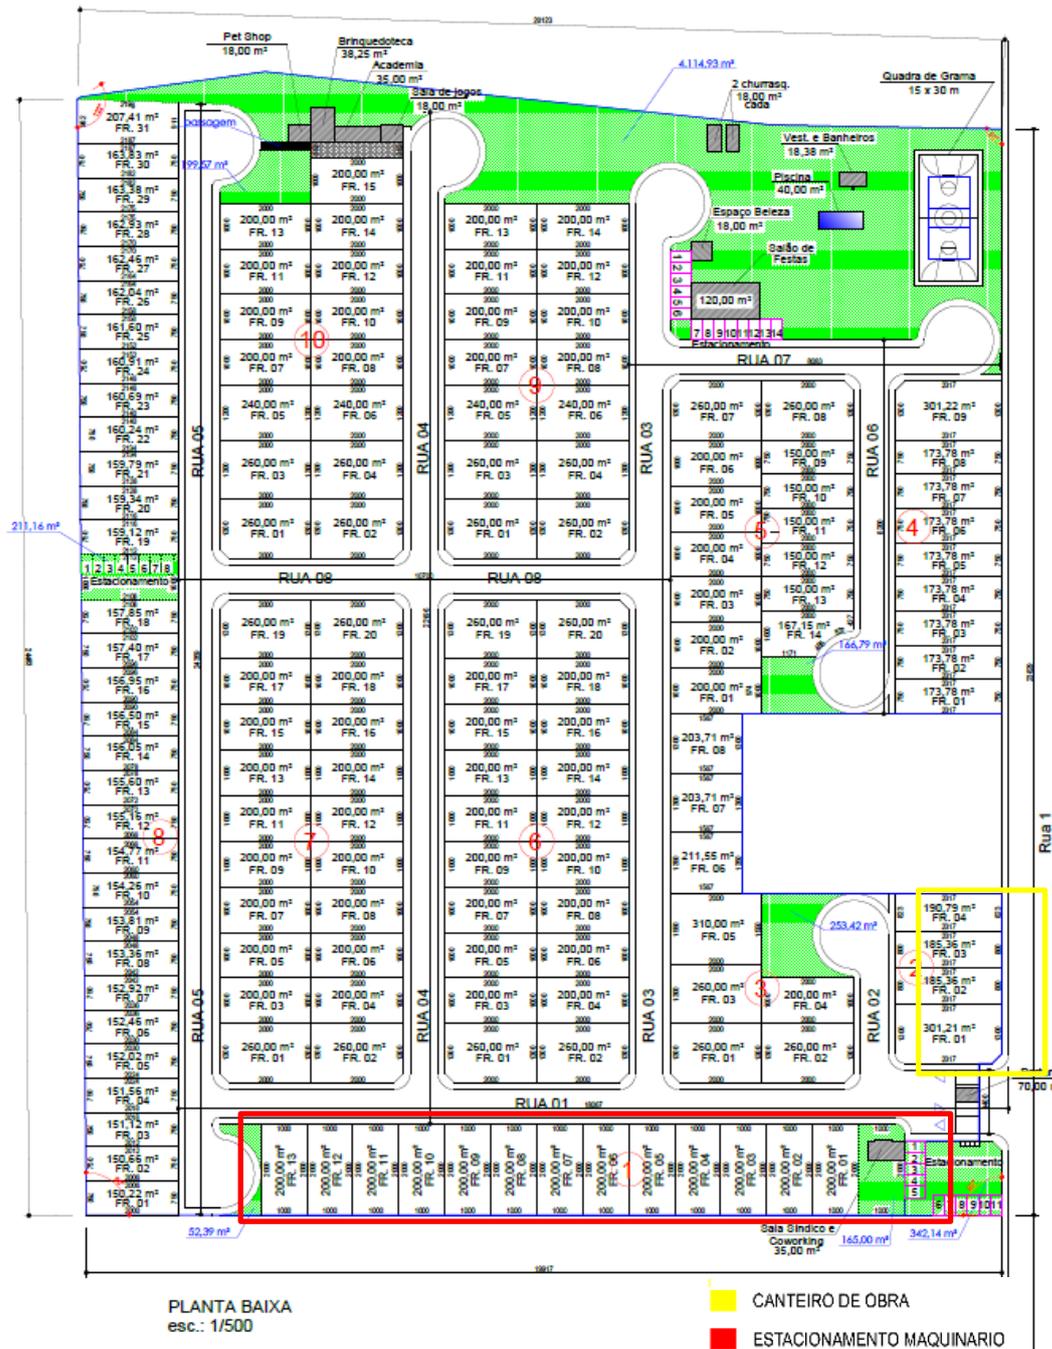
Previsão dos locais onde serão usados como canteiro de obra e estacionamento de caminhões
